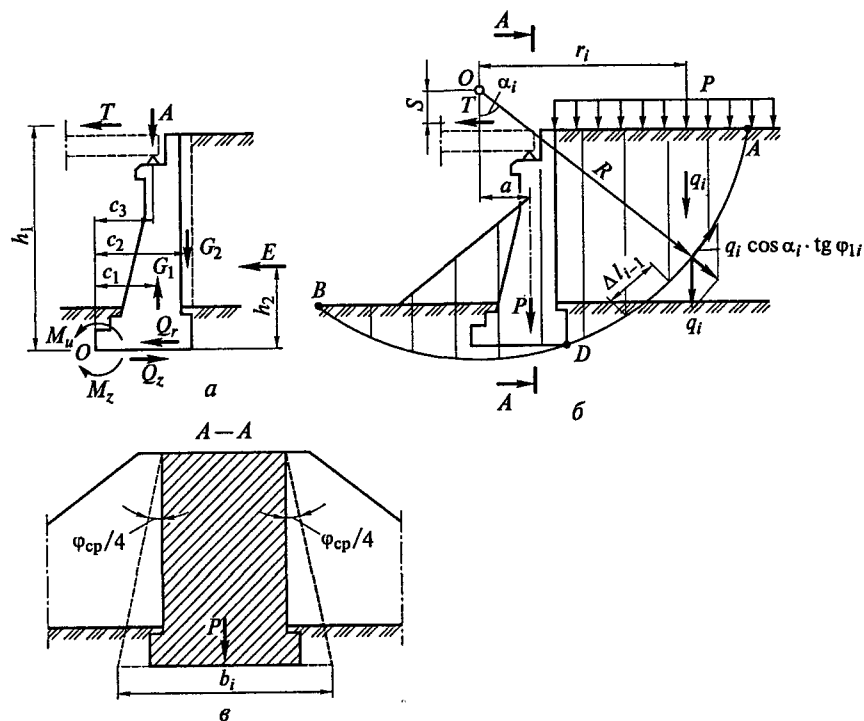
Схемы для расчета устоя на опрокидывание, горизонтальный сдвиг (а) и глубинный сдвиг (б, в)
